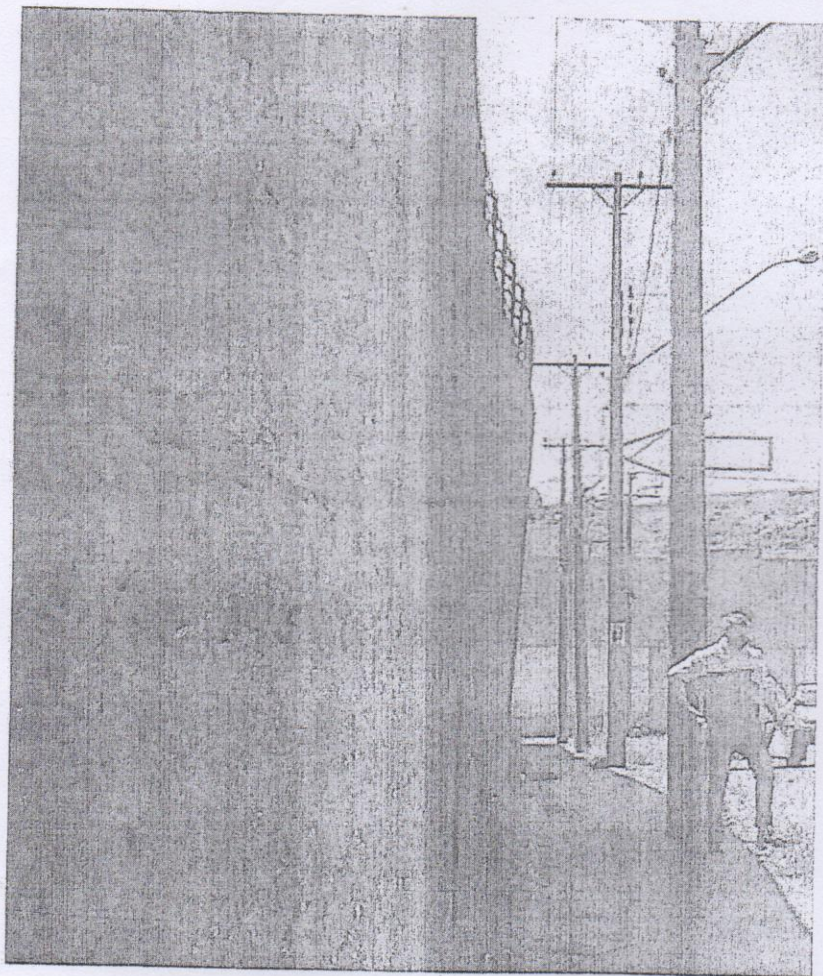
"EMBARRIGAMENTO" APARENTE NO TOPO DO MURO
